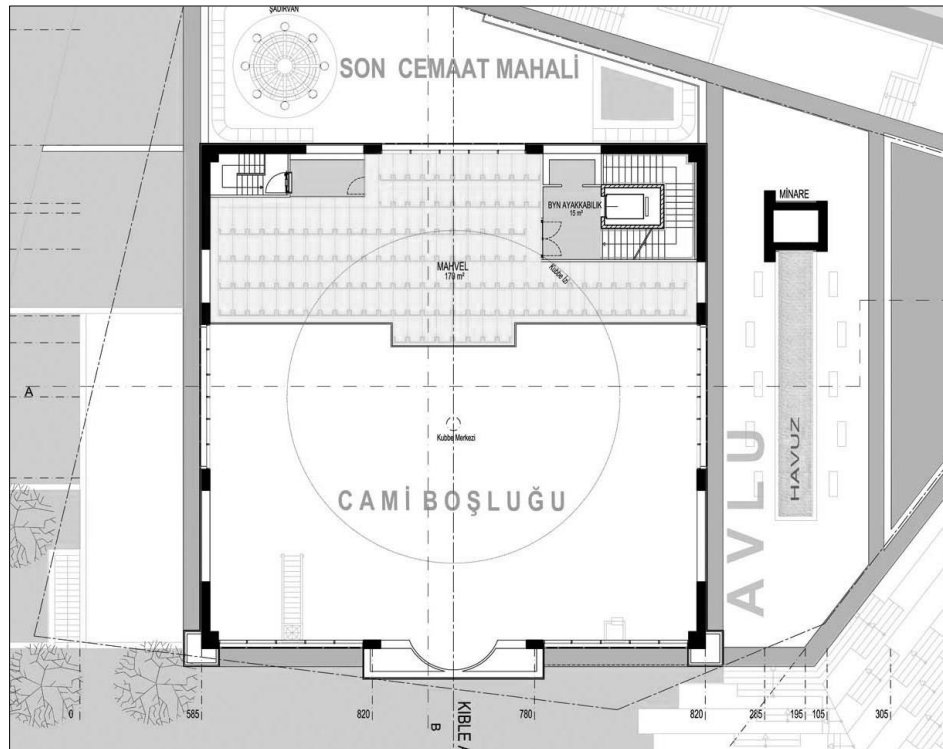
Alacaatlı Uluyol Cami vaziyet ve 1. Kat Planı, (URL-5)
